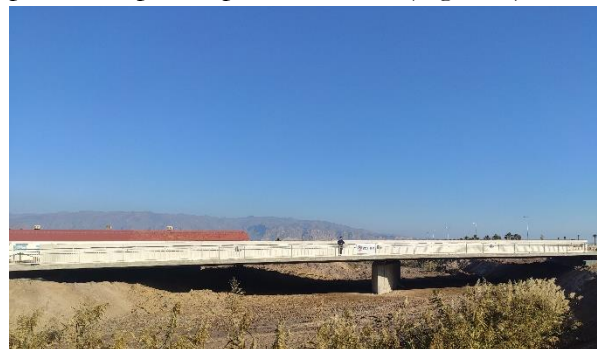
Vista del alzado del puente terminado previa a la inauguración
